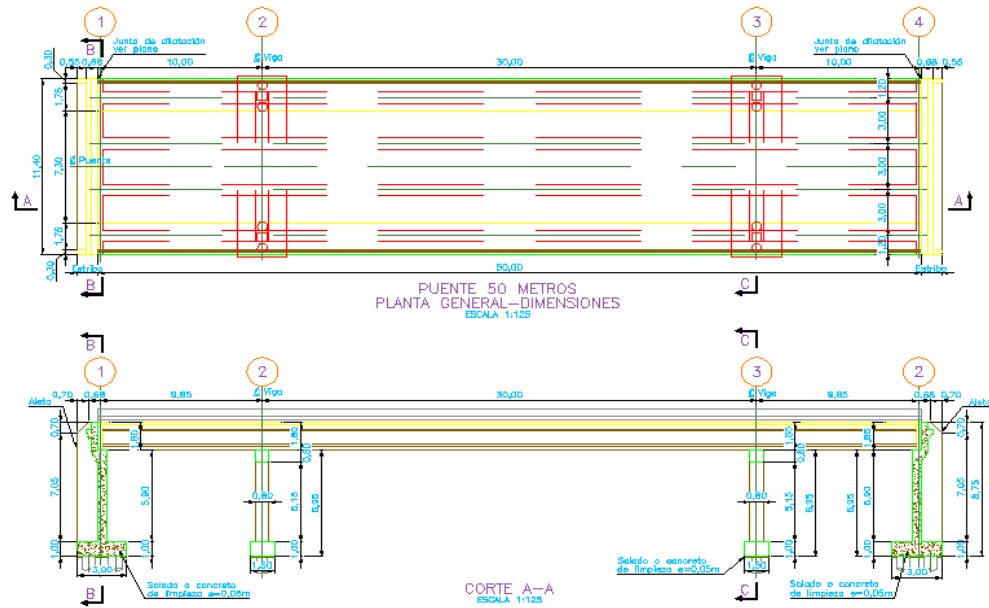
Sección Longitudinal en Planta y Corte – Puente 2
